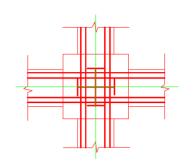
型钢混凝土 梁柱节点穿筋构造
